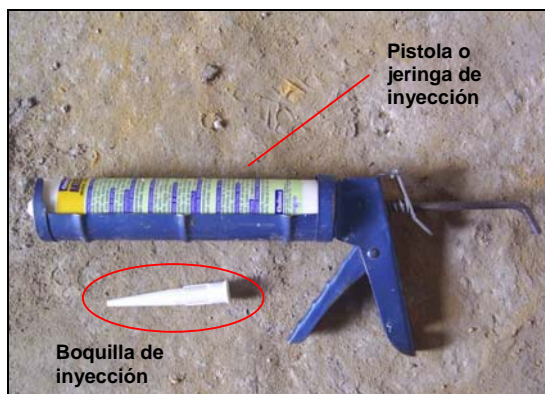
Herramientas utilizadas en la inyección de grietas con resina epóxica
